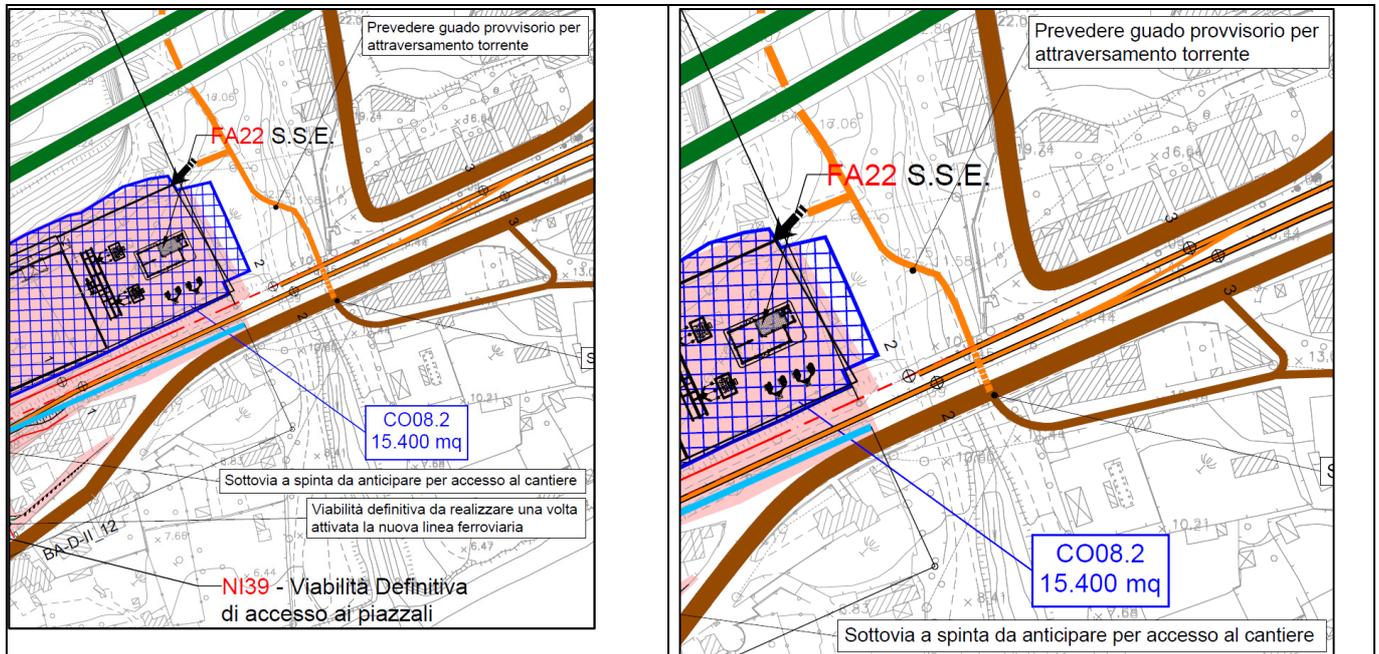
stralci planimetrici estratti da tavola " Planimetria delle aree di cantiere e relativa viabilità di accesso – tav.9/9 (1:2.000) - RS2S02D53P6CA000009B)
